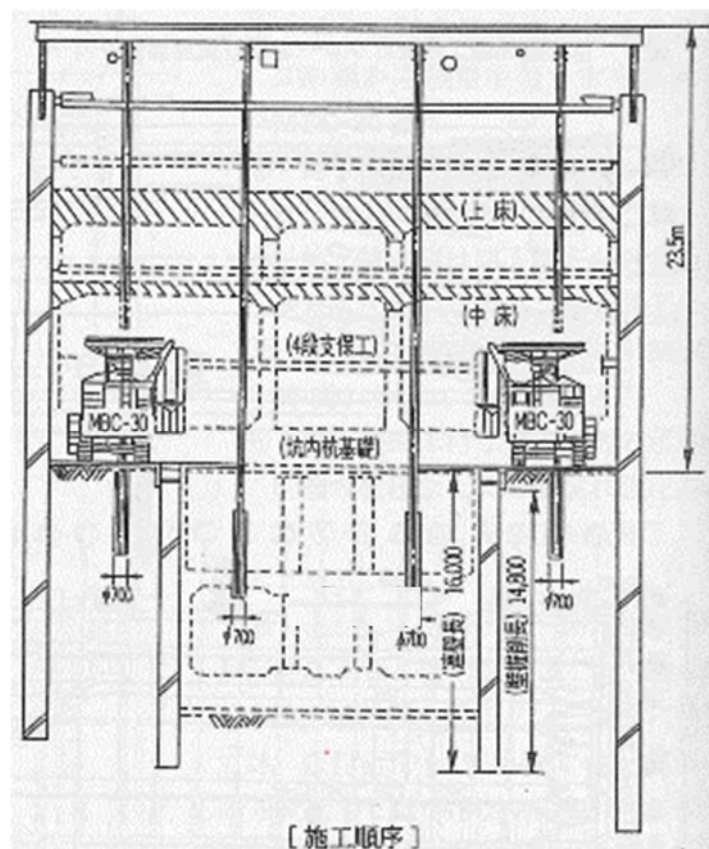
坑内地下連壁施工状況図³⁾
